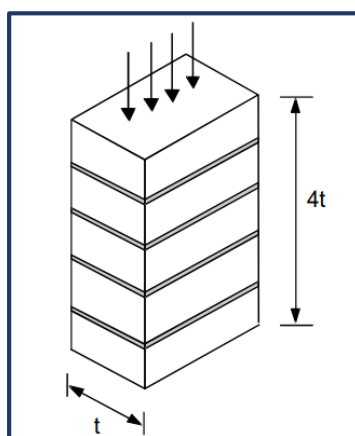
Ensayo de una pila para determinar la resistencia a la compresión axial de la mampostería sin reforzar.
